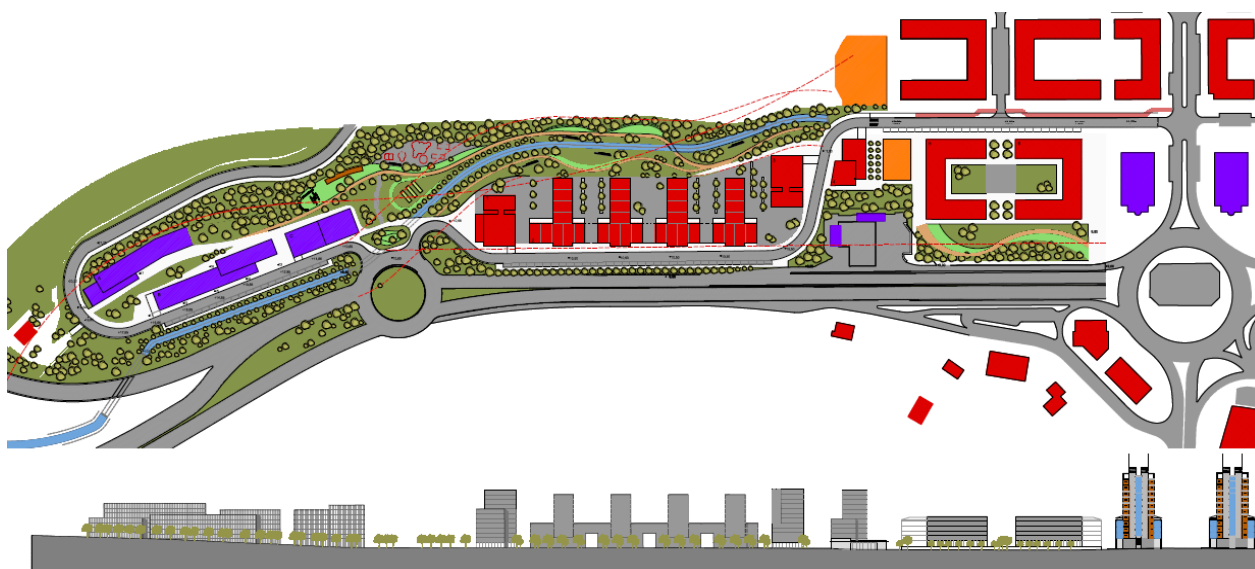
Planta y alzado general de la alternativa 3. Fuente: Modificación del PGOU.
